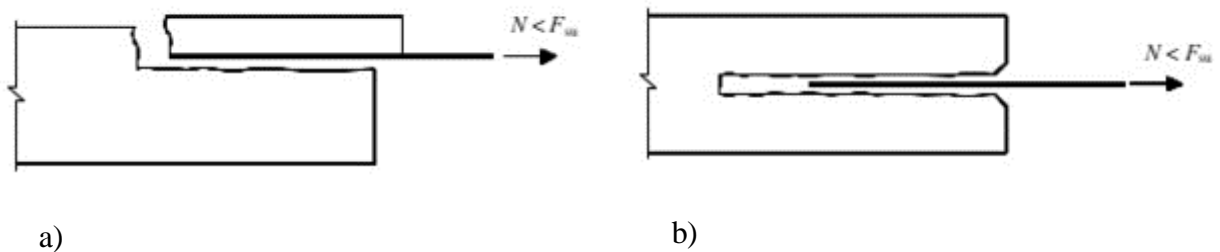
Generaliserade spänningsfördelningar då en armeringsstång med omslutande betong utsätts för ett dragtest (fib, 2008).
